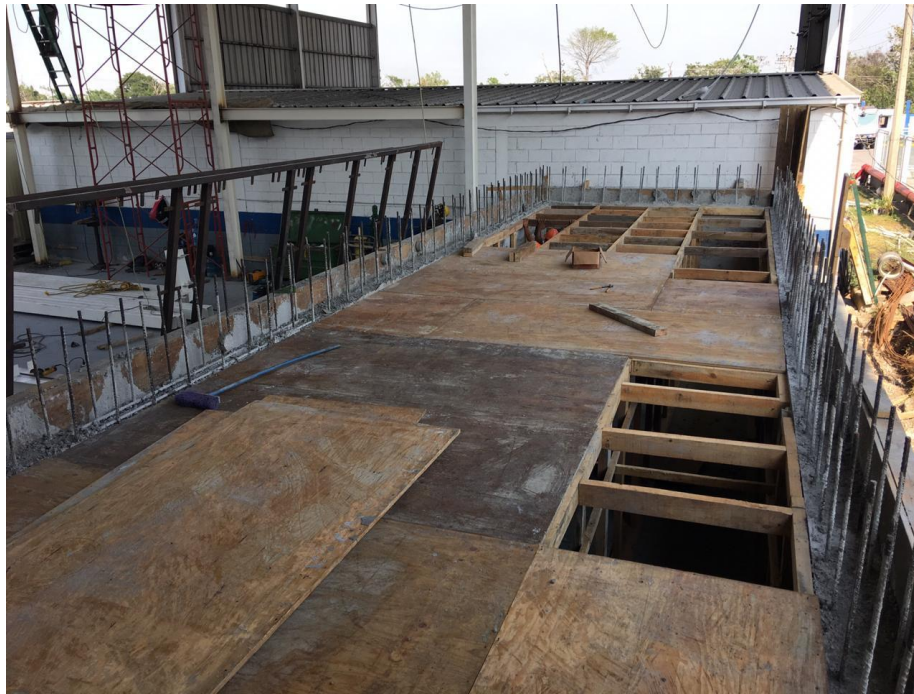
Encofrado para fundición de losa en tanque Heat Recovery
